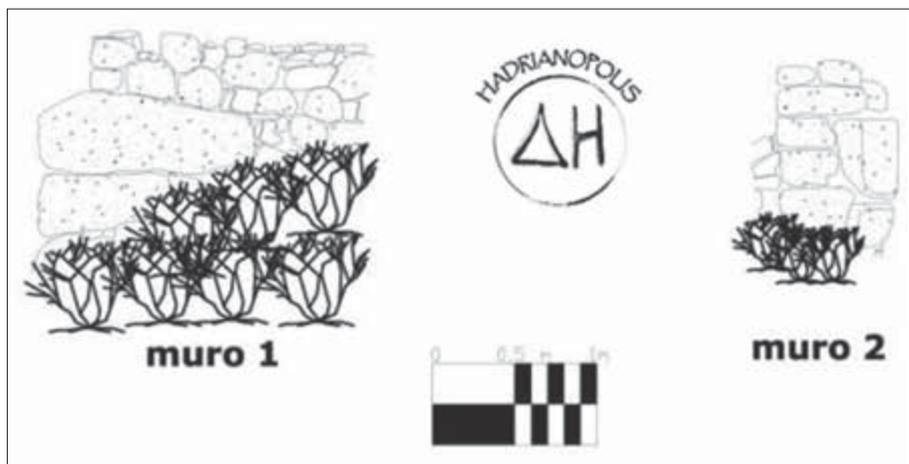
Spile, prospetto dei due stipiti all'ingresso del Santuario.
